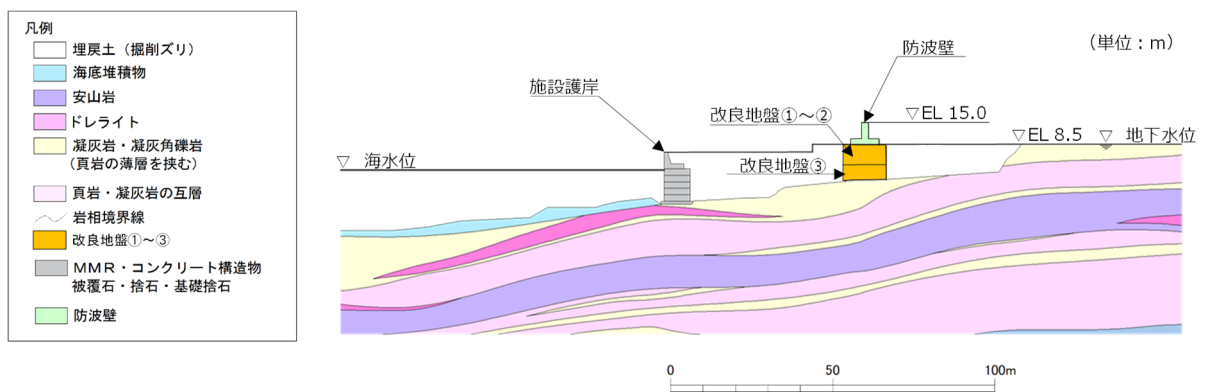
防波壁 (逆 T 擁壁) の横断面図 (⑥-⑥断面)
